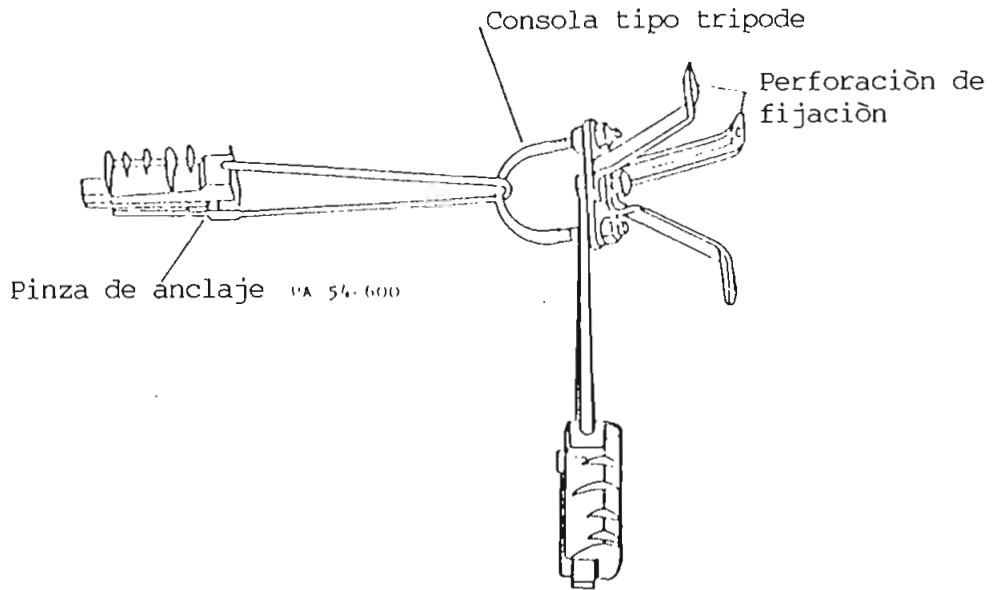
Conjunto de anclaje doble para redes tendidas sobre fachadas
